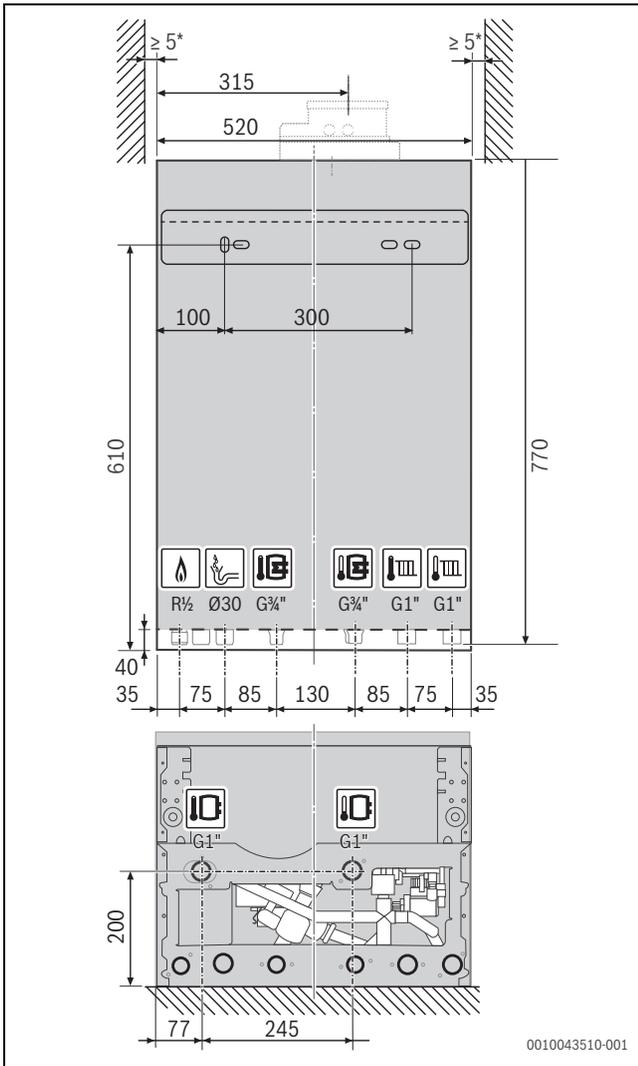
Frontansicht GB(H)192i.2 15-35kW(mm)
